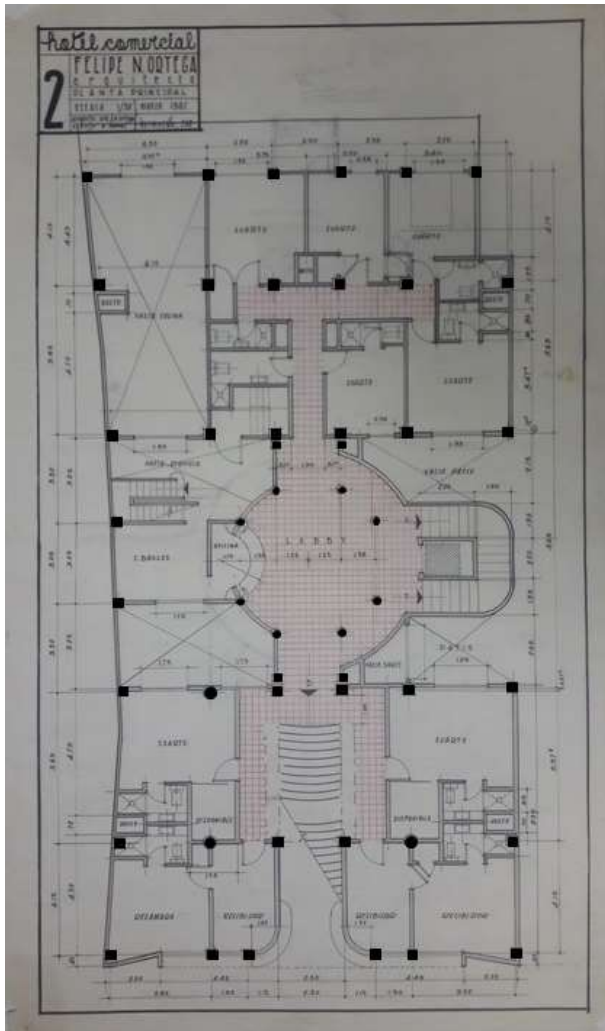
Planta del primer nivel lobby del hotel De Anza, se ha resaltado la retícula de columnas de su estructura.
